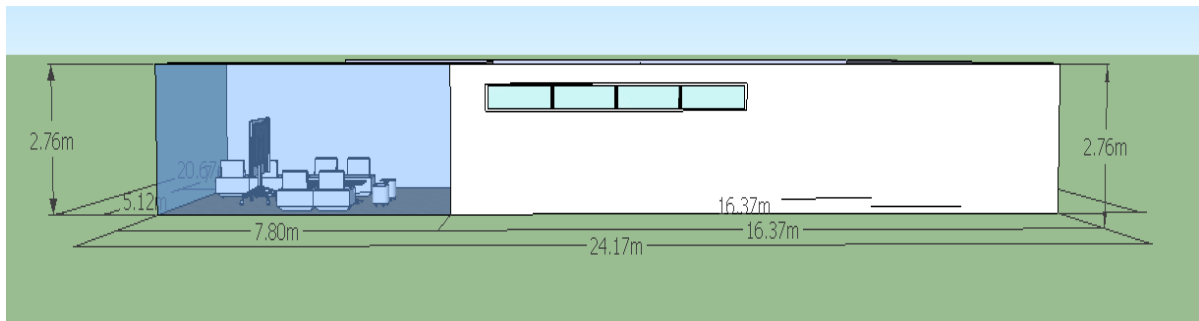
Vista de Planta con Estaciones de Trabajo
